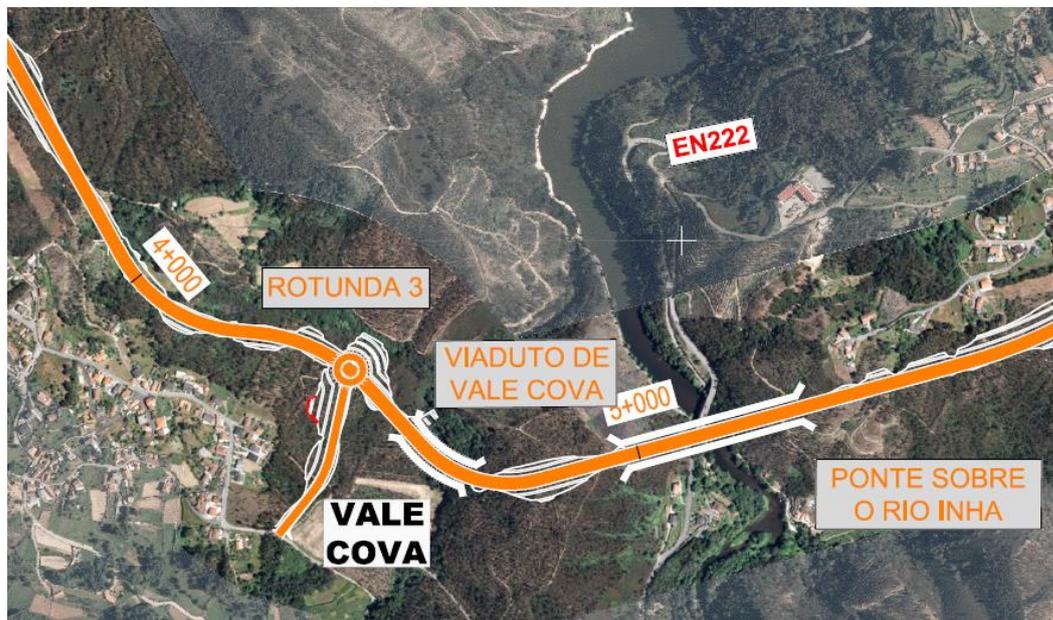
Localização em planta do traçado na zona de Sobreda, Serração e Vale Cova
